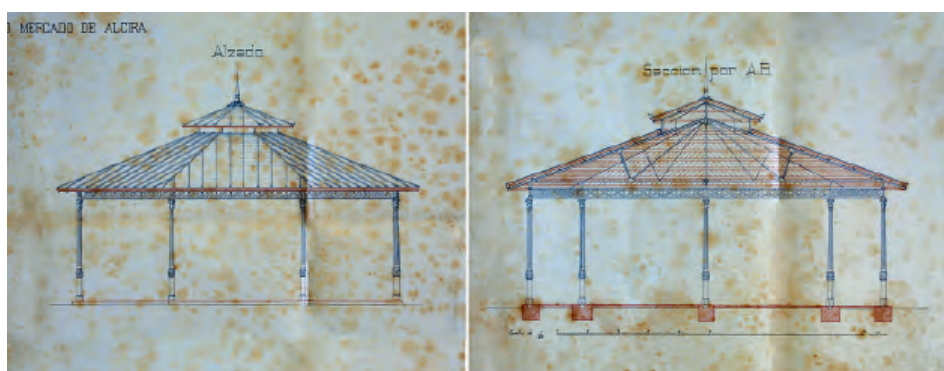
Antonio Martorell y Trilles, Proyecto de pescadería para el mercado de Alzira, 1884. Alzado y sección. Arxiu Municipal d'Alzira.
